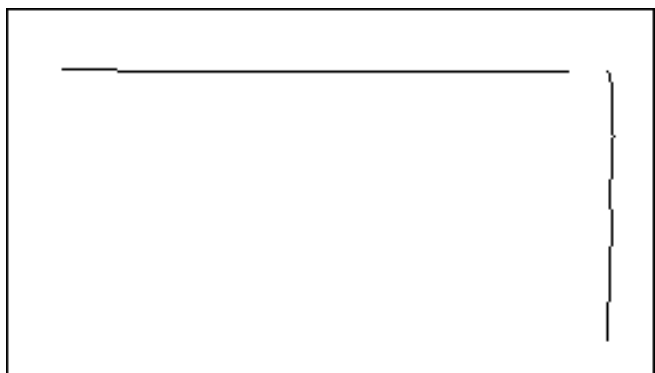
Se fisura el revoque en donde se encuentra hormigón (de las vigas o las columnas) con mampostería, cuando no se han previsto el uso de vendas de malla de fibra de vidrio.
